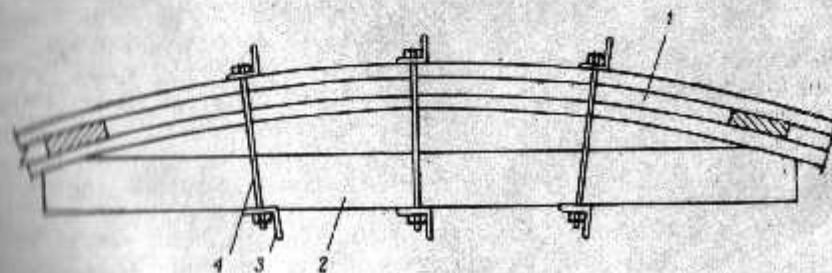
Выпрямление верхнего пояса дощатой фермы при деформации из плоскости конструкций
